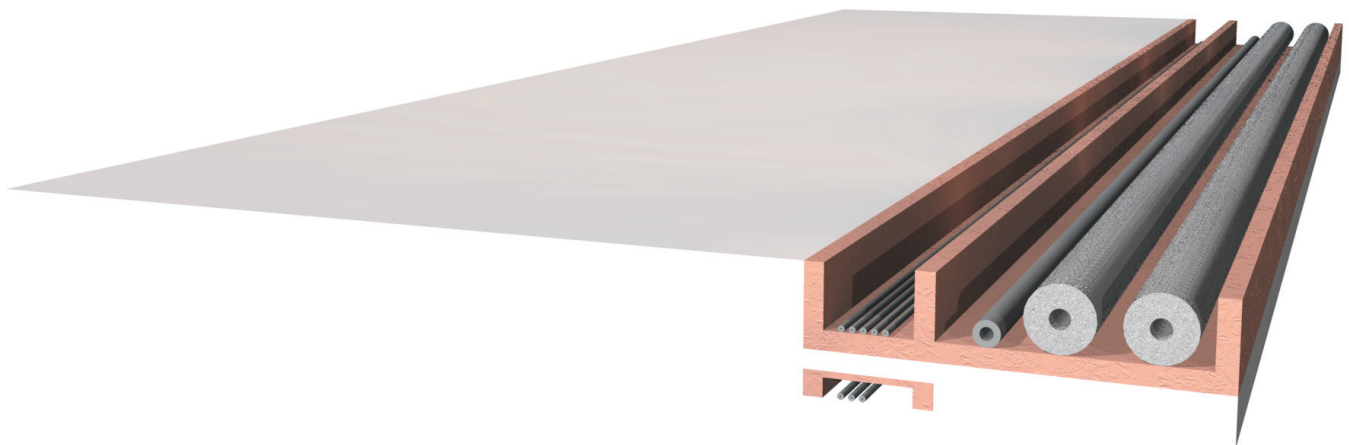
Installationen im Einfamilienhaus: Trassenführung im Boden-Decken-Element zwischen EG und 1. OG
